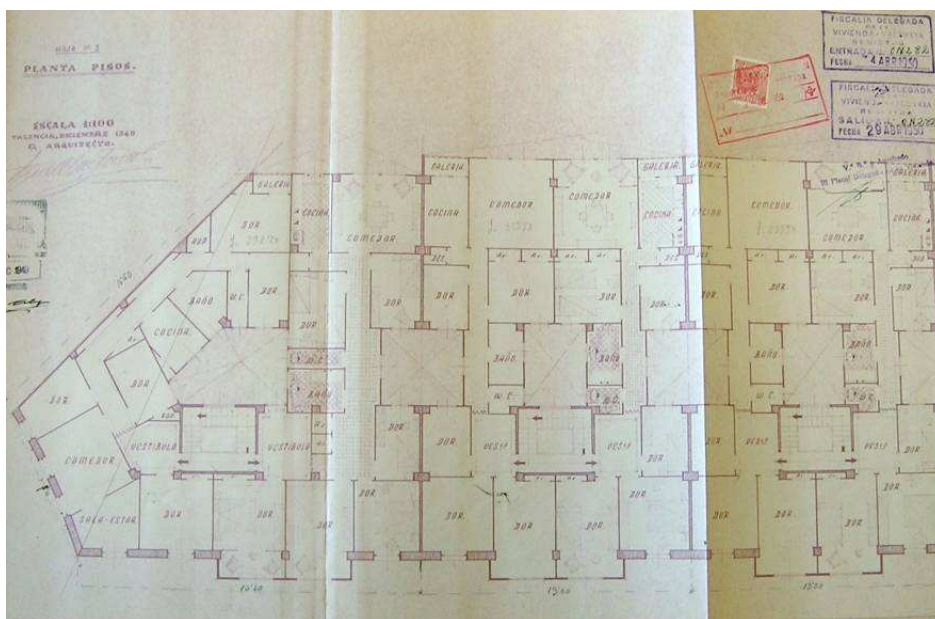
Planta de distribución. Edificio ficha 76C.008
